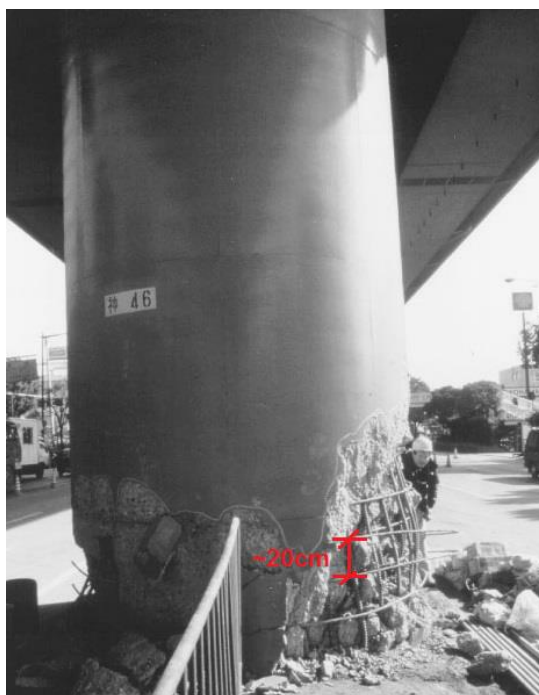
Rotura de um pilar por falta de ductilidade – espaçamento entre estribos excessivo, adaptado de [32]
